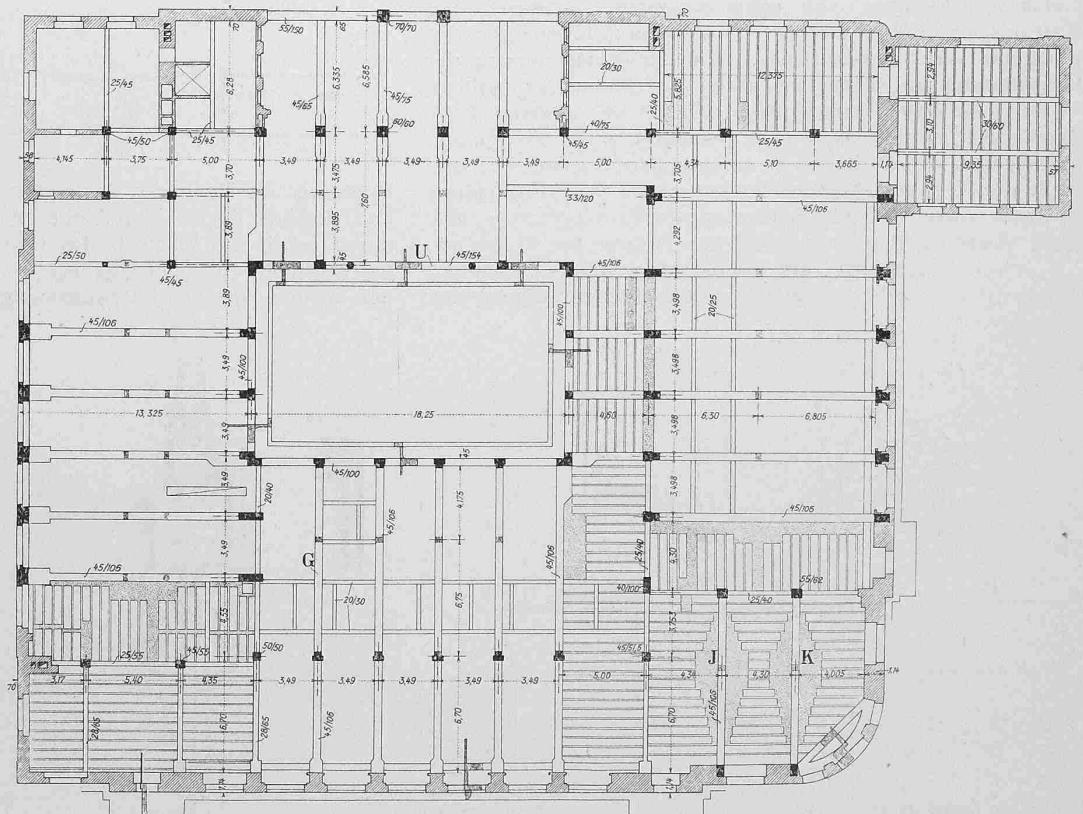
Grundriss mit Bindern und Decke über Erdgeschoss. — Masstab 1 : 400.
